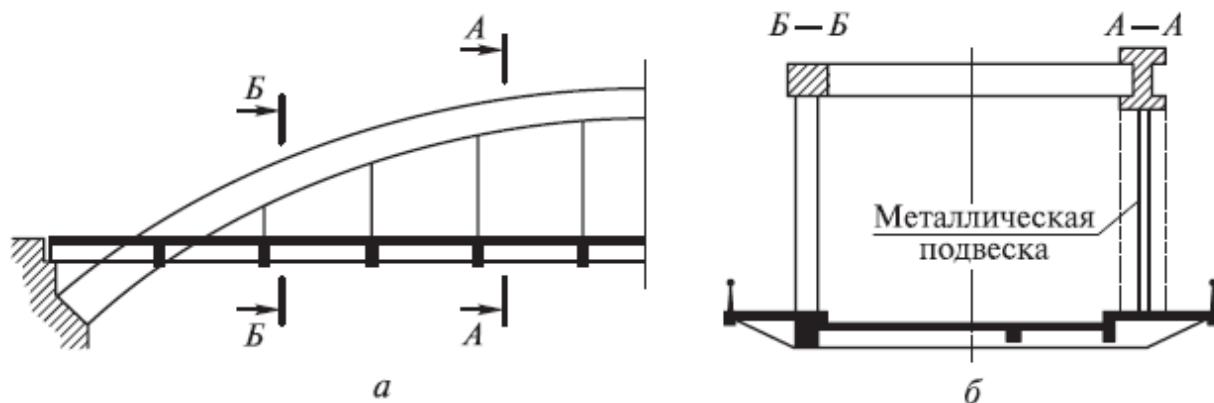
Фасад (а) и поперечное сечение (б) арочного моста с ездой понизу
